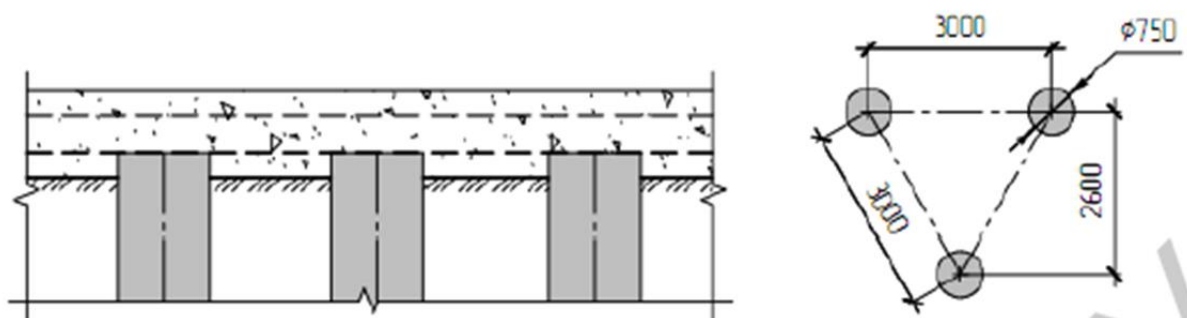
Схема укрепления основания грунтоцементными колоннами
